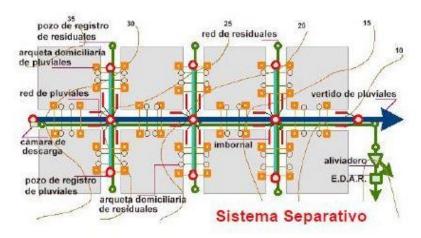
Sistema de alcantarillado separativo. Tomada de internet.
